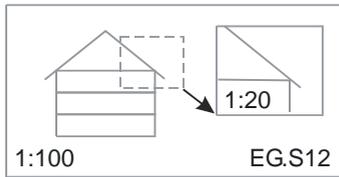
Layoutplan mit Gesamtgeschoss und Ausschnittsdetail
